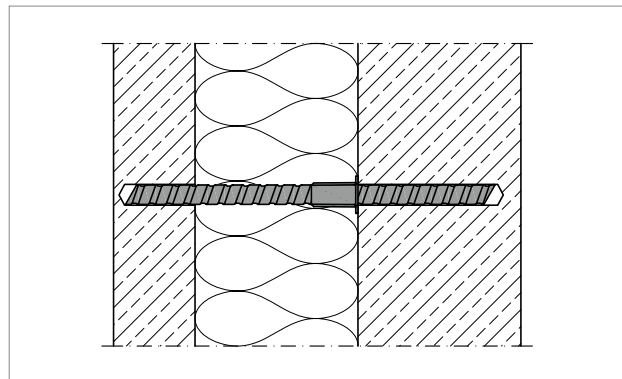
Schöck Isolink® Typ C: Verankerung in Sandwichwand
